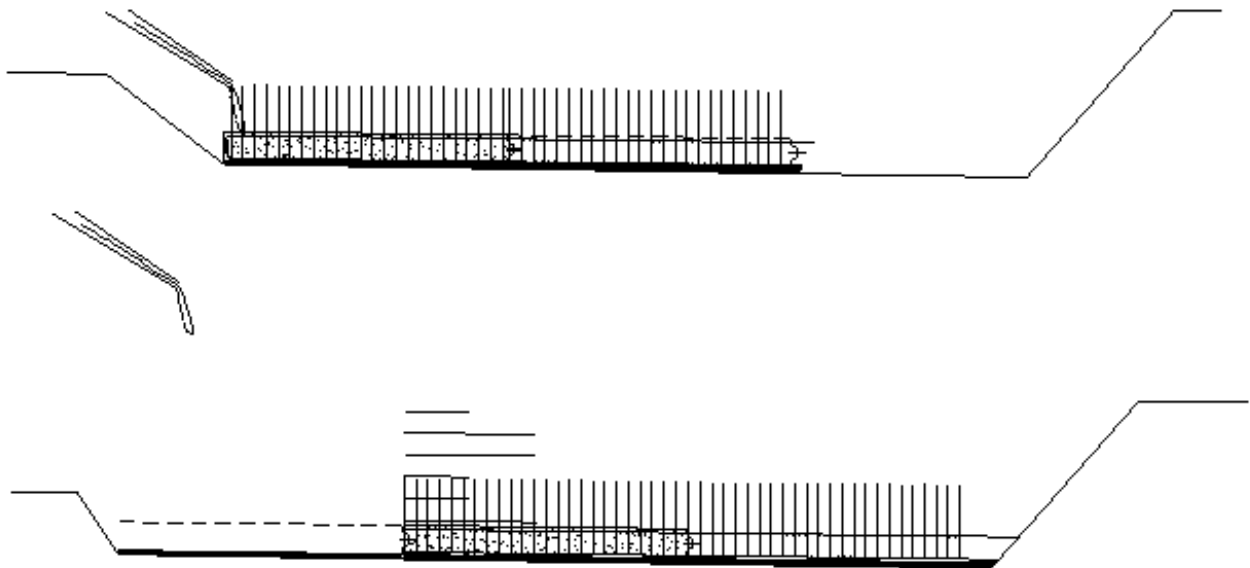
Colocación de plantilla y colado de losa de fondo de pasos de fauna.
